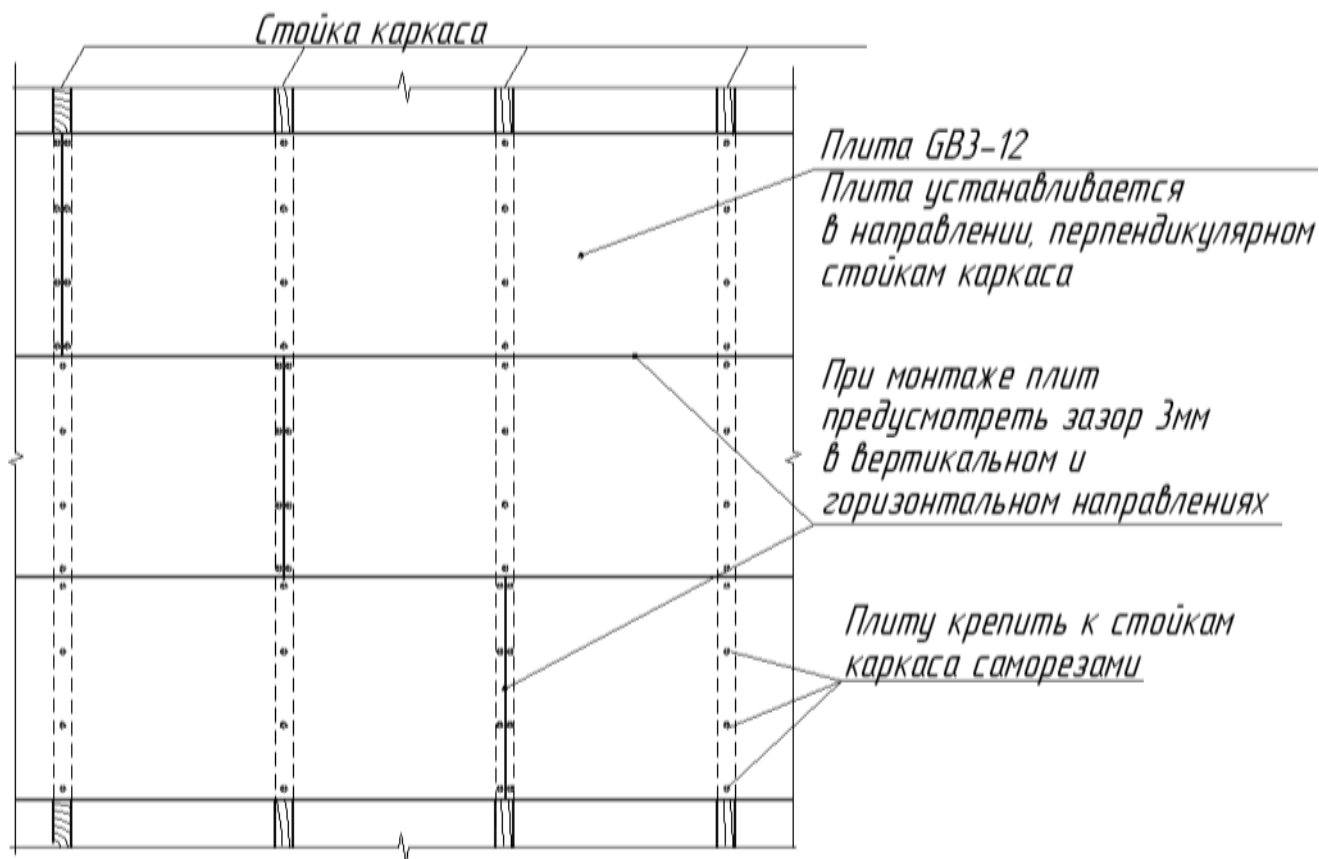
Схема установка плит GB-3F (GB-3) на стойки каркаса горизонтально
